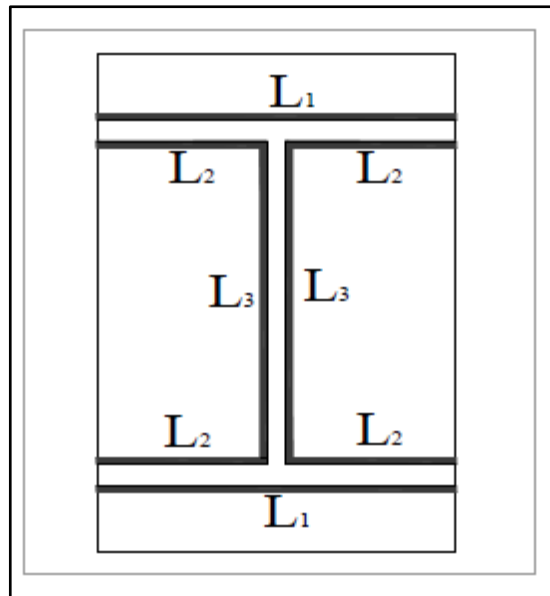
Assemblage soudé poutre-platine [12]
